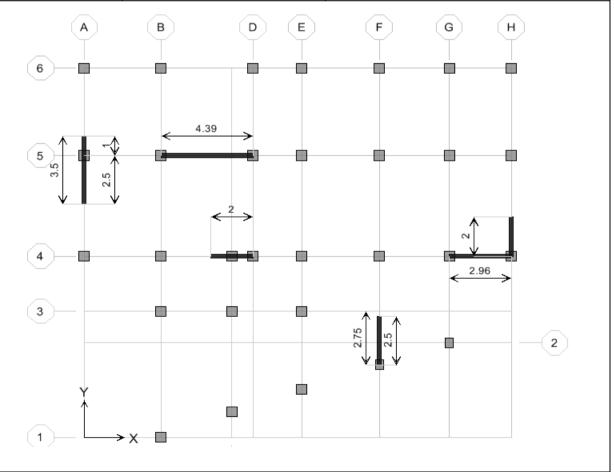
Vue en plan des éléments structuraux (Poteaux - Voiles) de la super – structure
